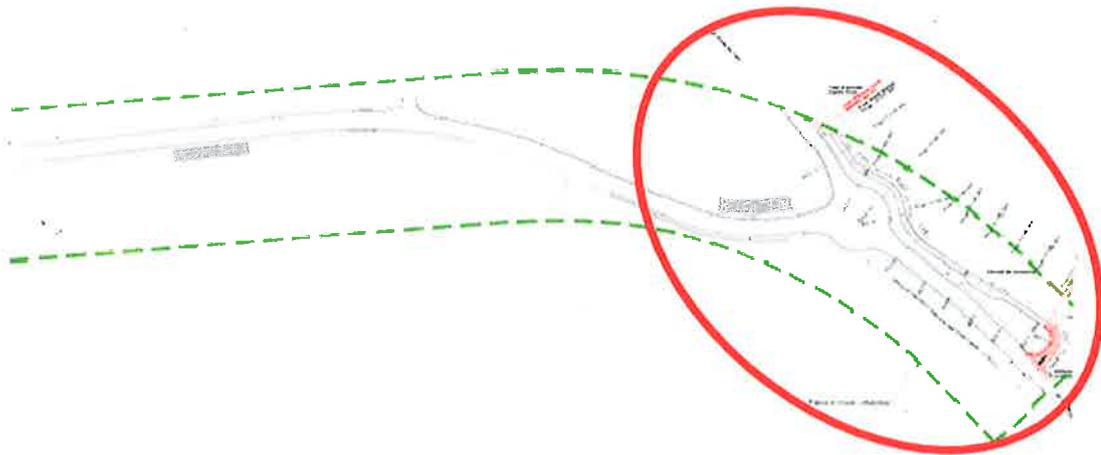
Stralcio Planimetrico intervento oggetto di variante
